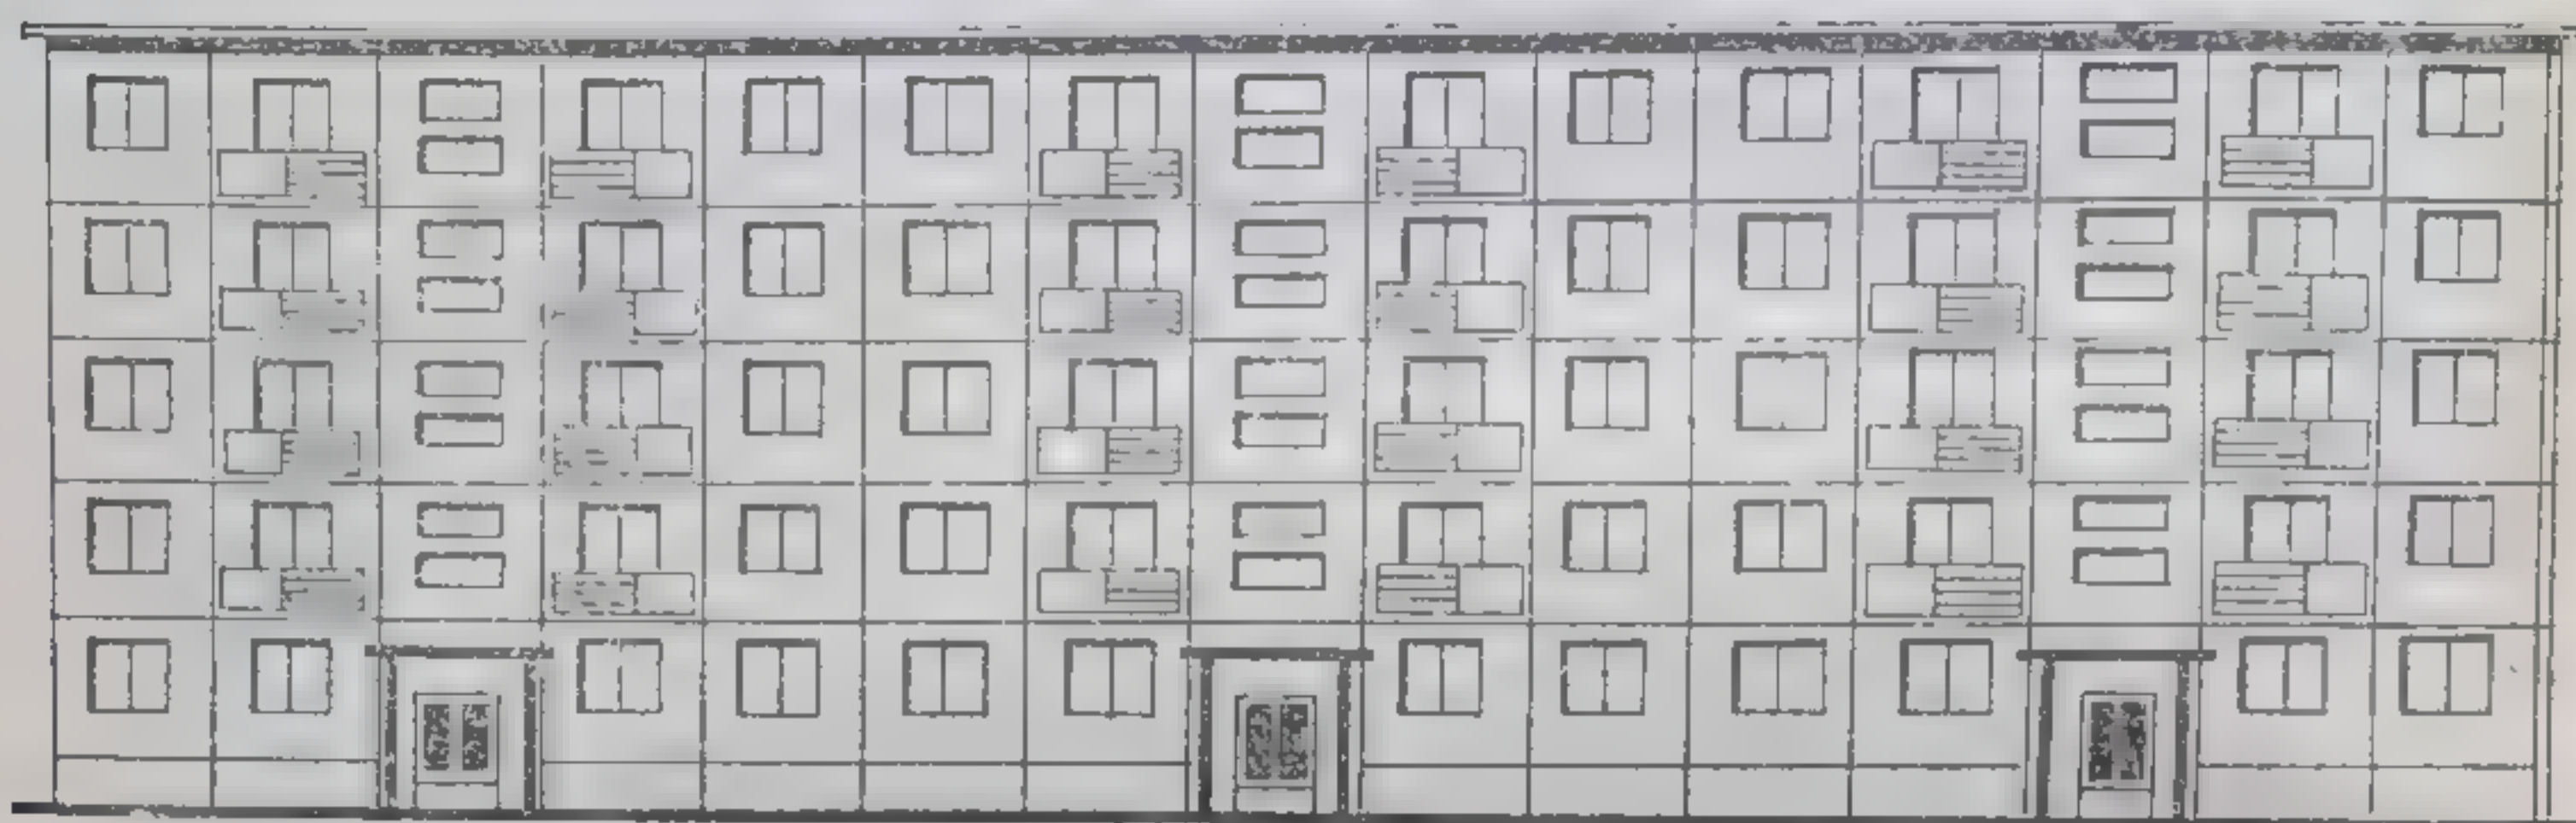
Пример архитектурного решения фасада 5-этажного жилого дома из объемных блоков
